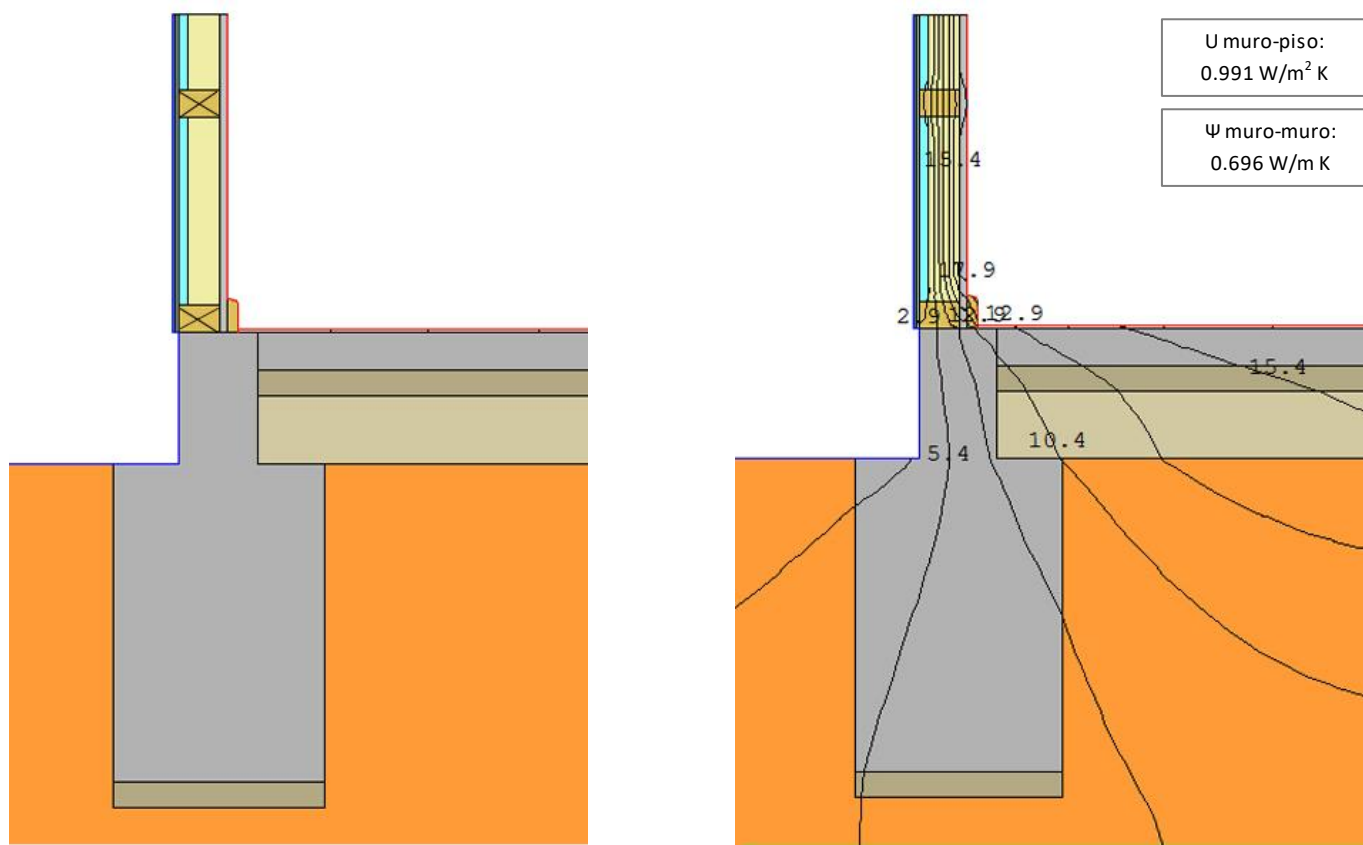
Detalle y diagrama de isotermas unión muro-piso, en vista de corte utilizando Muro Base
